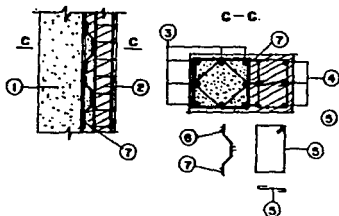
Conexión por medio de conectores entre el refuerzo longitudinal (Ref.15)
